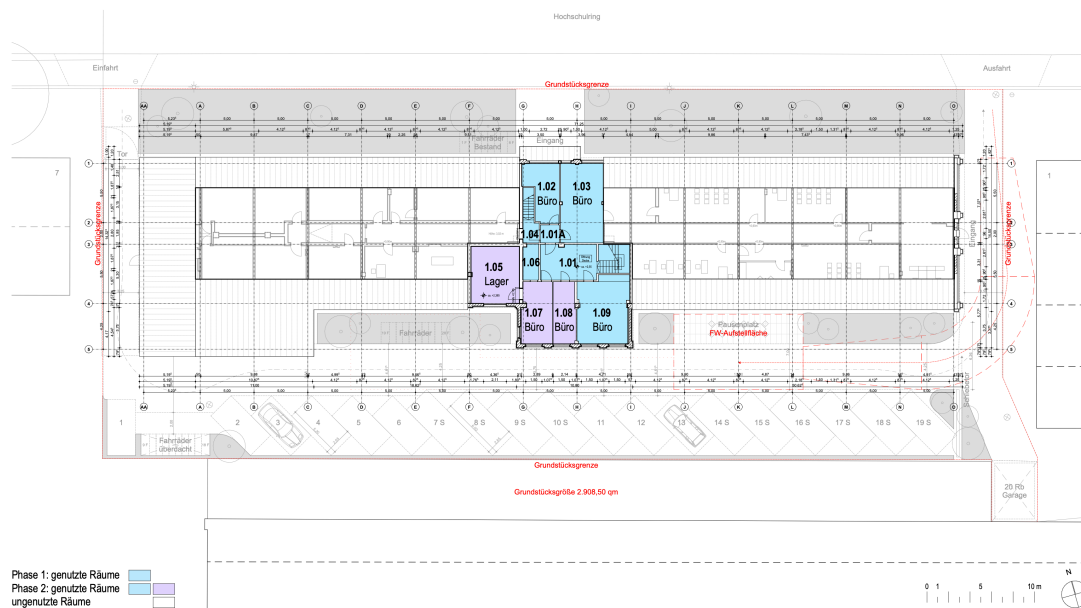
Phase II – Erweiterung der Nutzung – Grundriss OG
